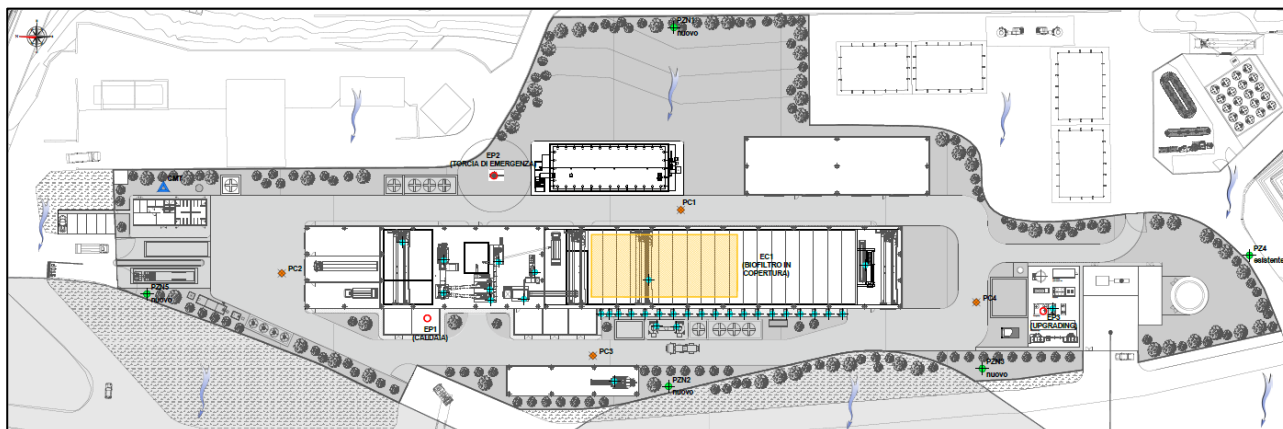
Stralcio tavola T.19 - Planimetria di monitoraggio
